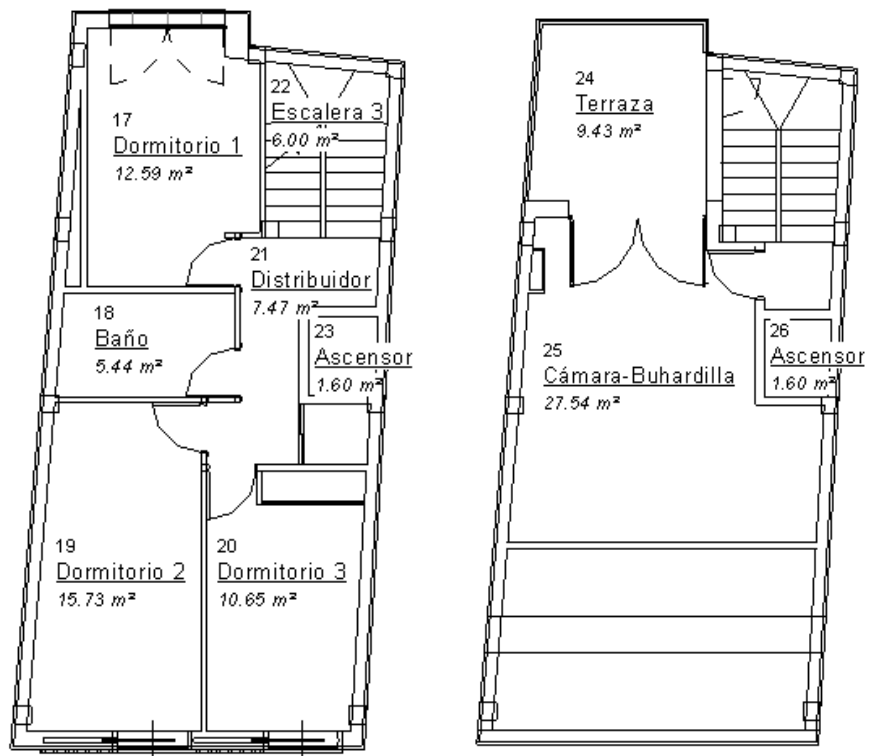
Planos planta vivienda. Fuente: Elaboración propia con software Revit 2017
